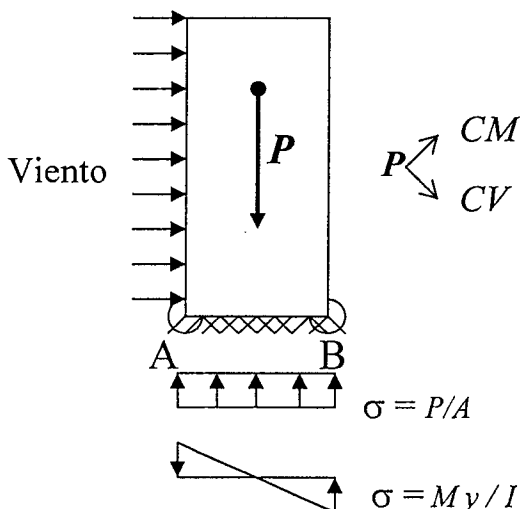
Efecto estabilizante de las cargas muertas y vivas
